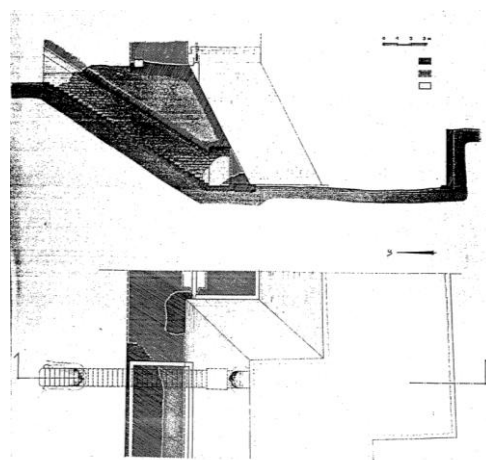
Plan et coupe de la poterne par Negev, après dégagement et avant restauration
